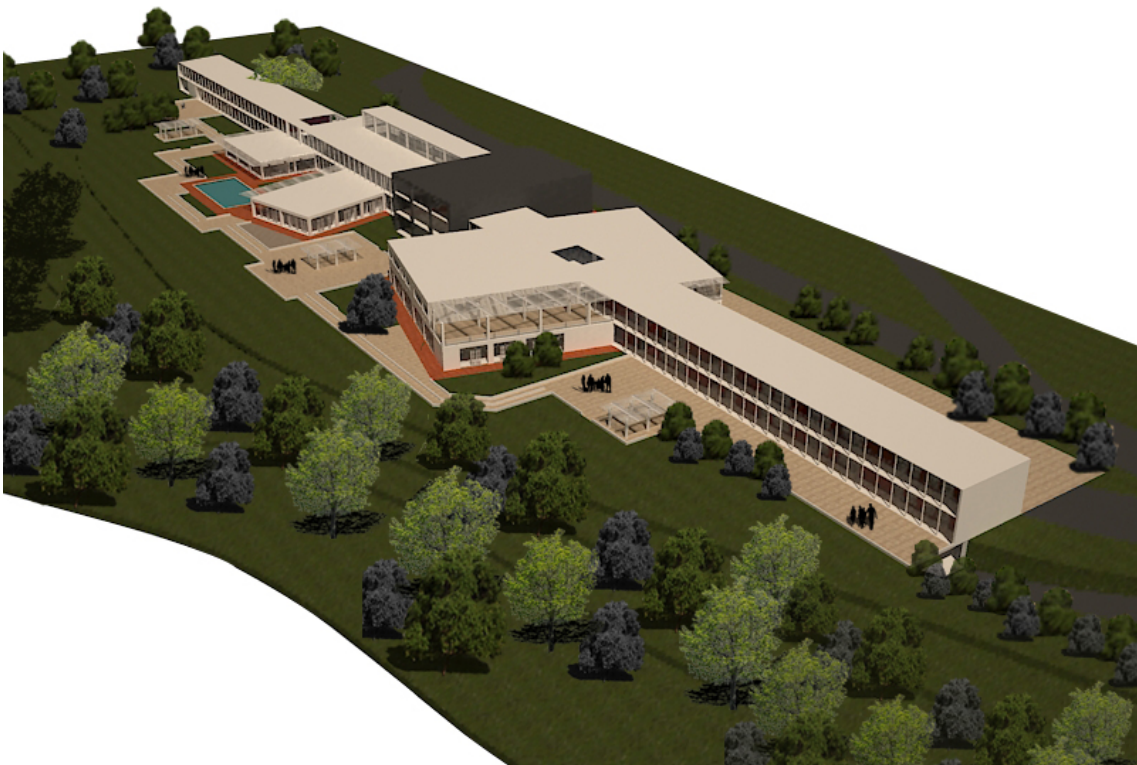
PERSPECTIVA GENERAL DEL PROYECTO
